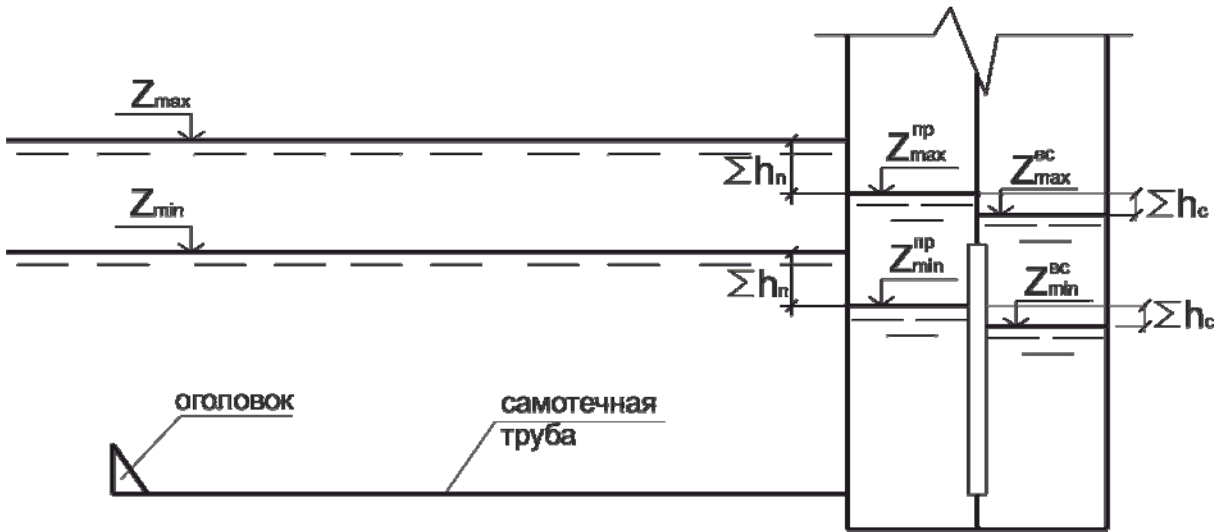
Схема к определению отметок расчетных уровней воды
